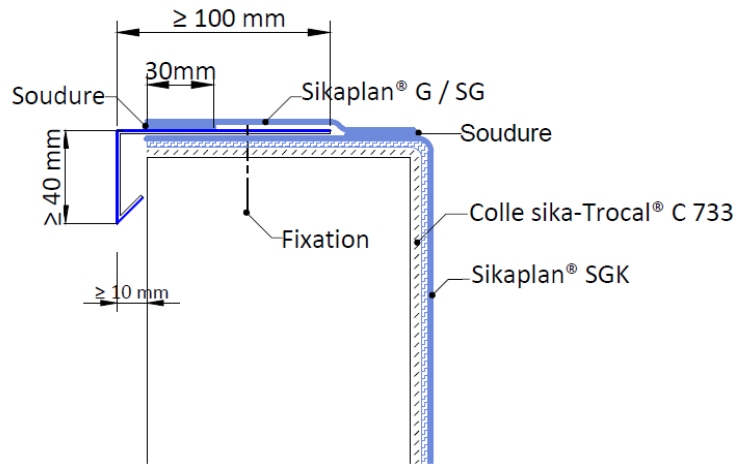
Finition de la membrane Sikaplan® SGK sous bande de rive en Sika Tôle Plastée PVC
